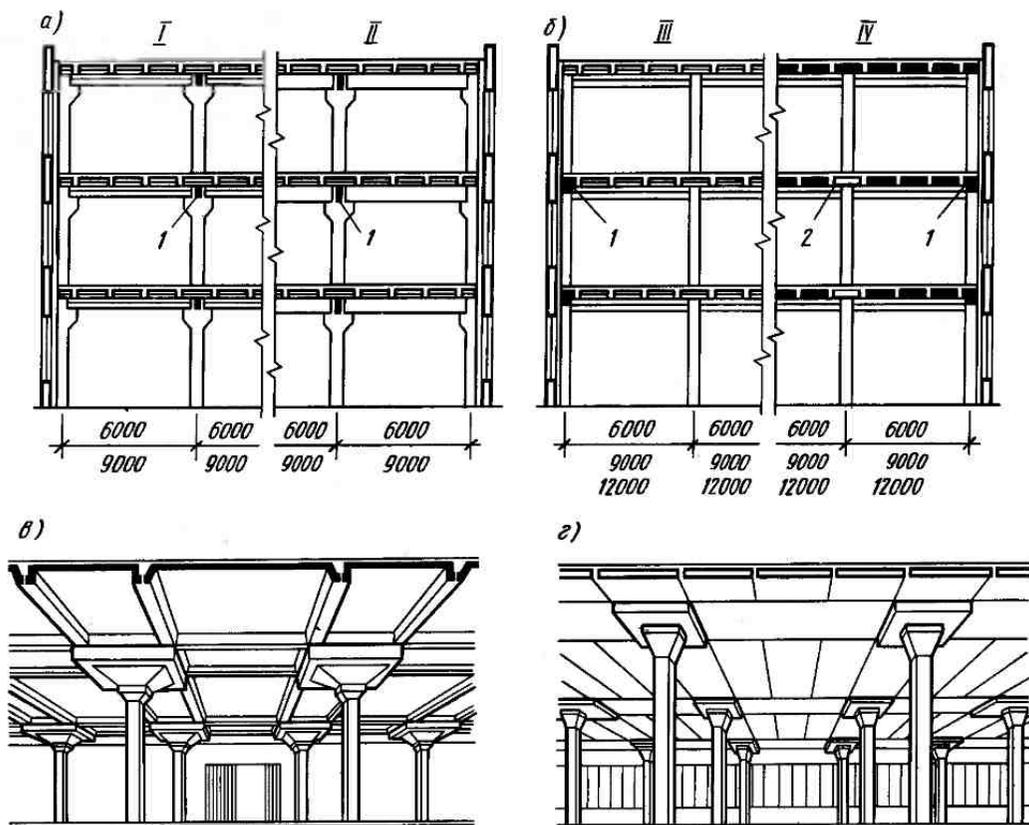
Каркасы многоэтажных промышленных зданий:
